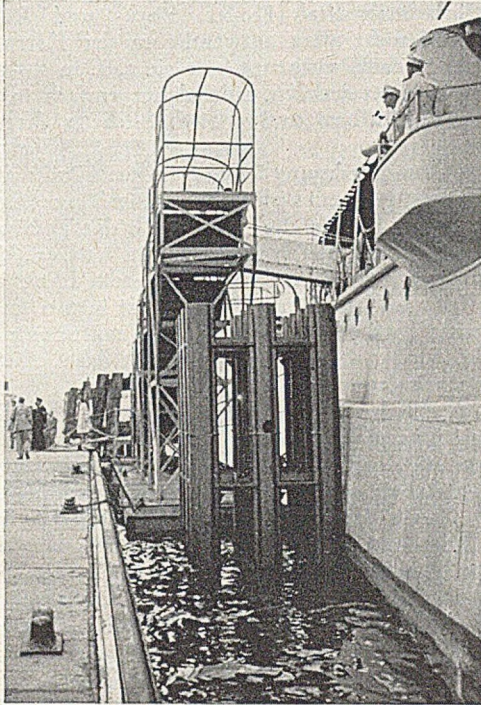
12-pfählige Stahldalbe (KP 24) an der Überseebrücke in Hamburg.
